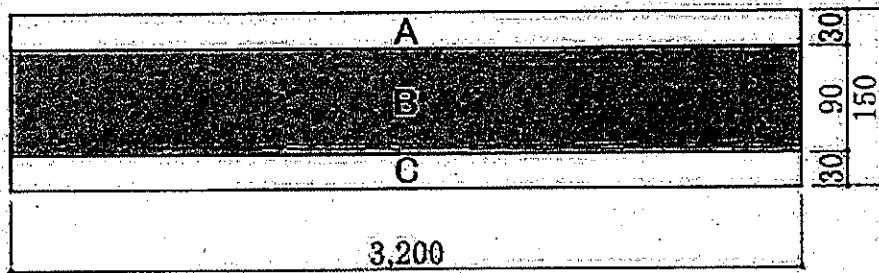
含水率測定位置 (平面図: 外層はヒキ、内層はスギ)
